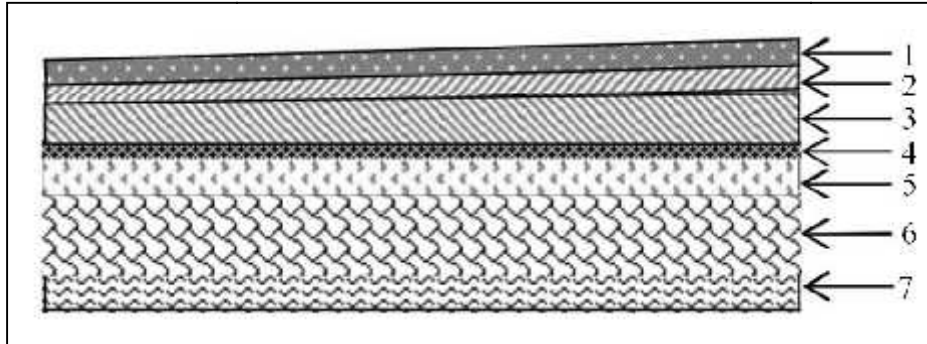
Figure II.5 : Coupe verticale d'un plancher
